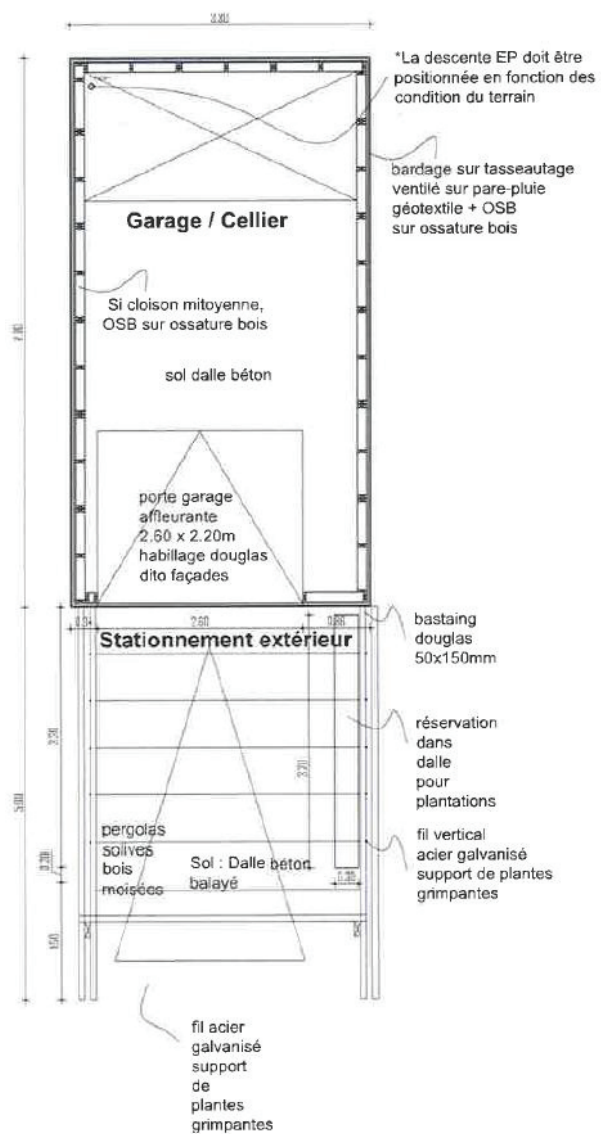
Exemple constructif (document non contractuel) dans le cas d'une construction d'une pergola + cabanon bois (vue en plan)
